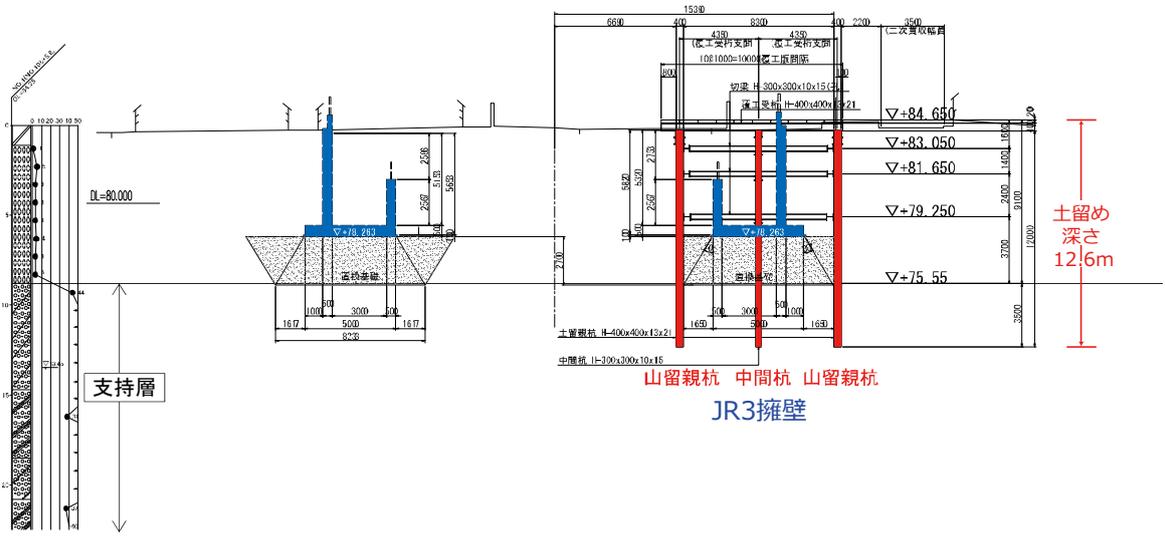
(2) 擁壁工縦断面図・横断面図 (JR3 擁壁)
